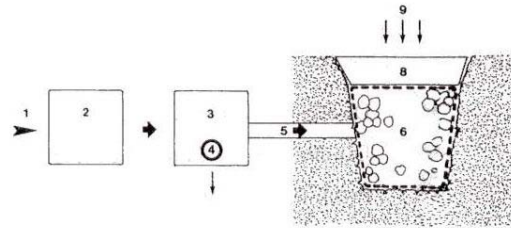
Esquema de los elementos principales de un pozo de infiltración. 1.- Alimentación, 2.- Decantador (opcional), 3.- Cámara de rebase (opcional), 4.- Rebase, 5.- Tubería de conexión, 6.- Pozo, 7.- Geotextil, 8.- Cubierta, 9.- Alimentación superficial (opcional).
